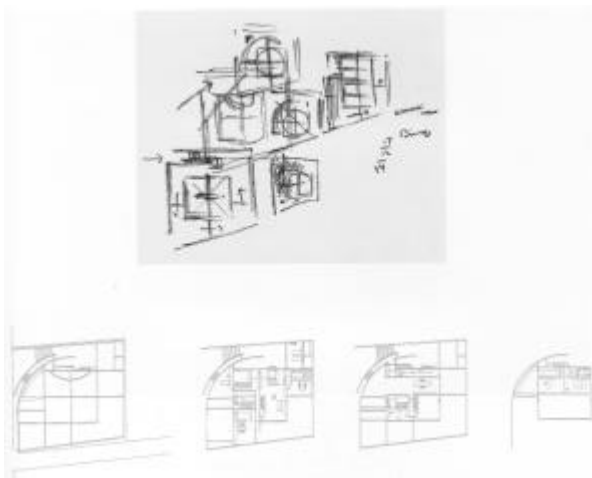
Tadao Ando, Haus Kidosaki, Tokio, 1982-1986, Grundrisse und Skizzen (aus: Dal Co 1995, 199)
